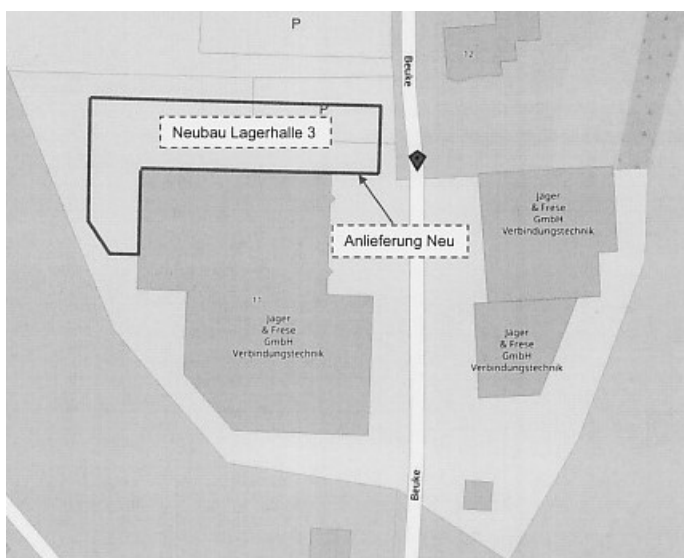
Lageplan mit der geplanten Halle 3 mit geplanter Anlieferung
